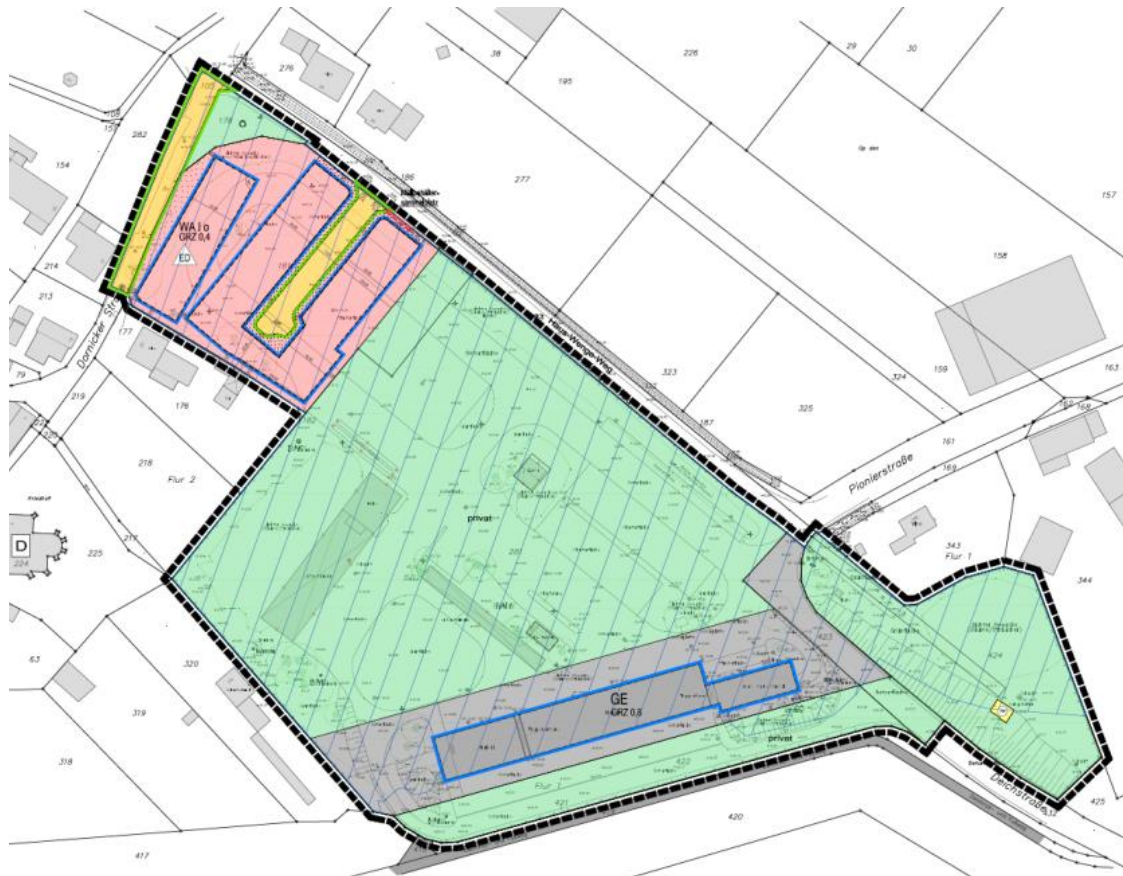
Vorentwurf Bebauungsplan Emmerich D 2/1 „Pioniergelände“
